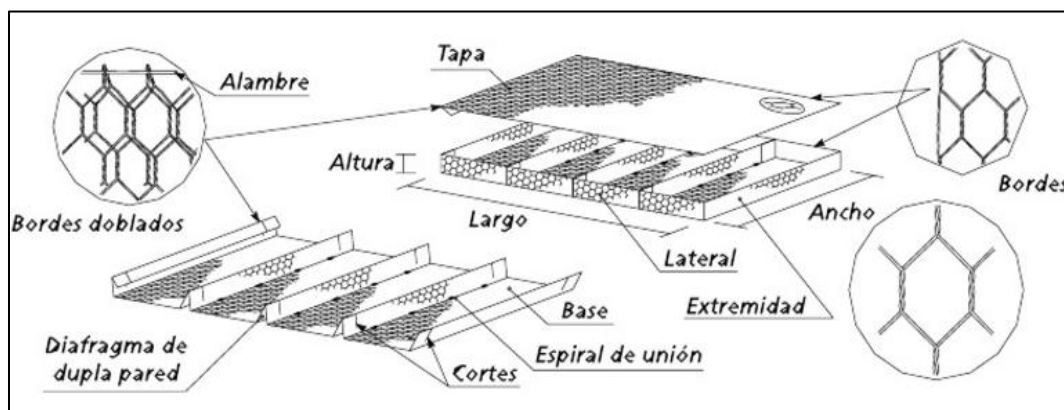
Principales elementos que constituyen un colchón reno.
